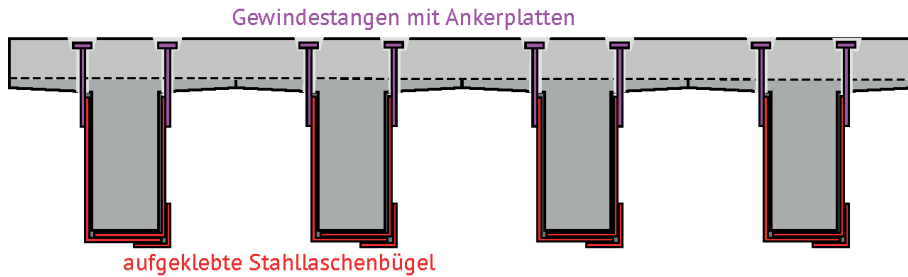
Ausführung einer Querkraftverstärkung mit aufgeklebten Stahllaschenbügeln, aus [6]
